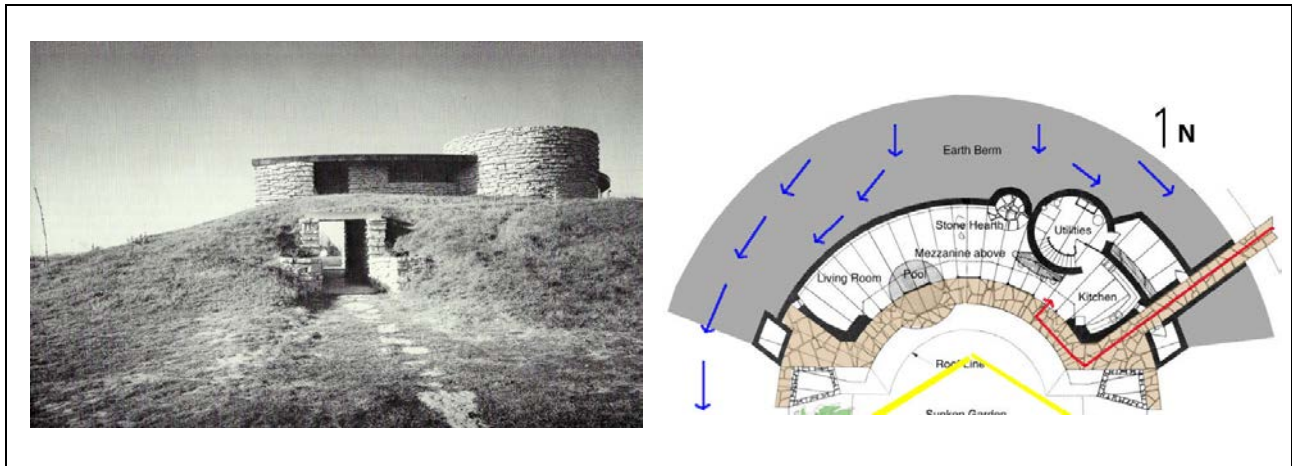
Vue du tunnel d'accès, après sa construction (7) et plan de rez-de-chaussée en montrant l'accès à la maison.
